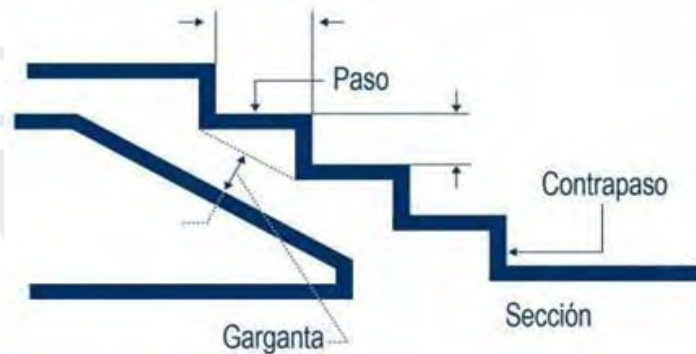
1. Partes de una escalera – Concreto Armado 2
